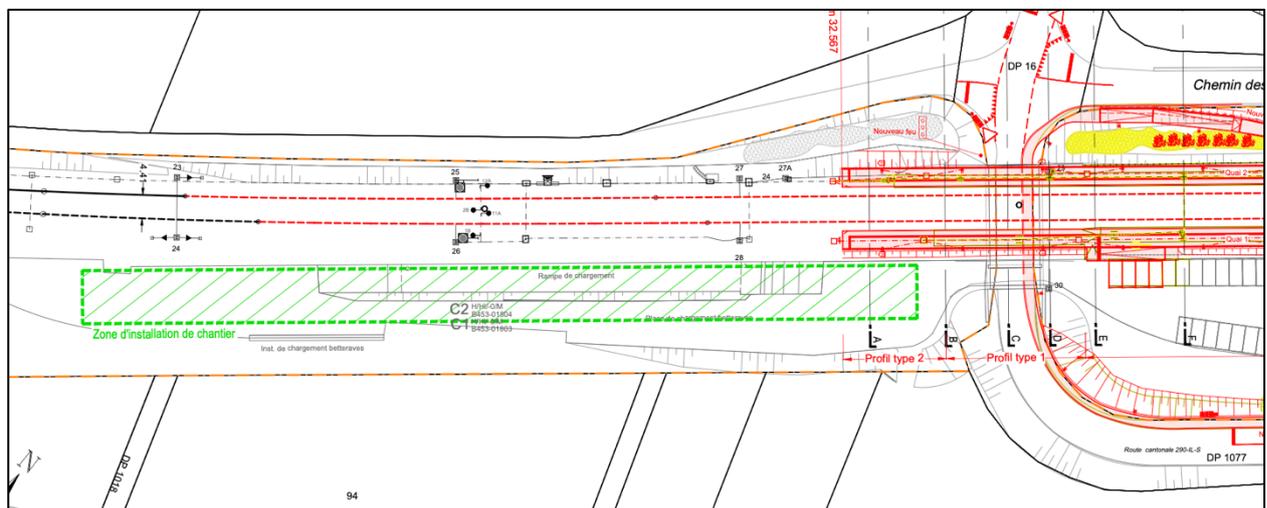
Situation de l'installation de chantier – extrait plans de situation général de PGS
